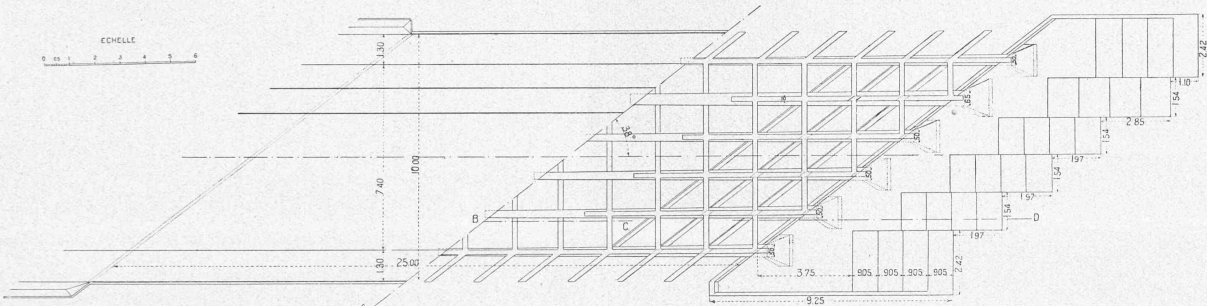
Plan. (Le hourdis étant supposé enlevé sur la moitié droite).
